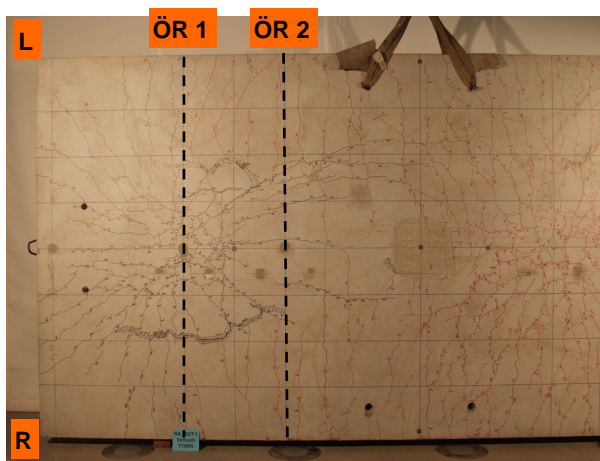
Rissbild auf der Betongurtoberseite
